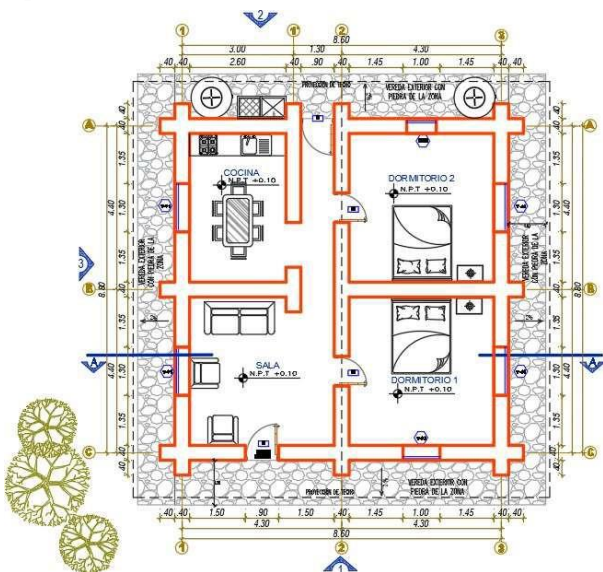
Distribución general de la propuesta, elaborado mediante AutoCAD. [1]
